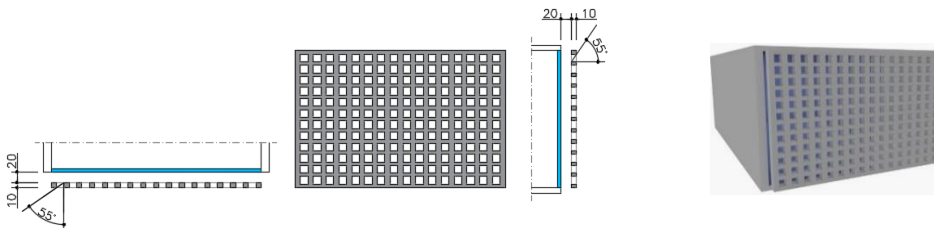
Planta baixa, vista, corte e perspectiva esquemáticos do Modelo I
